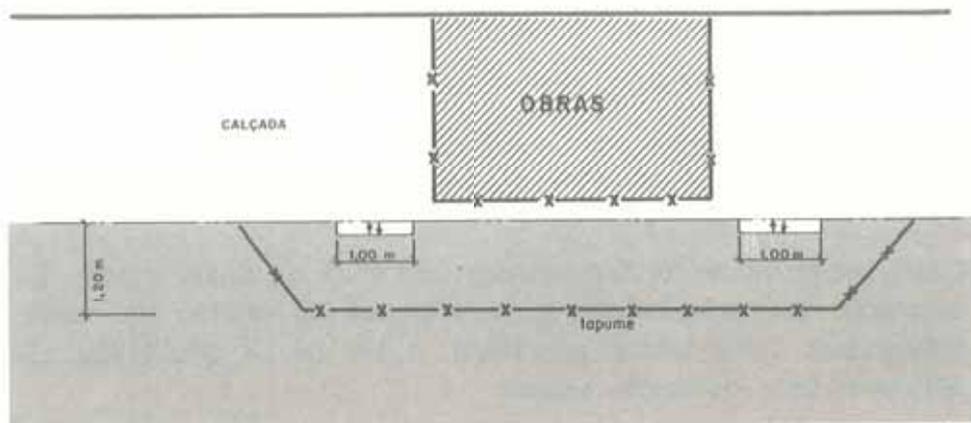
OBRAS NA CALÇADA — PLANTA
